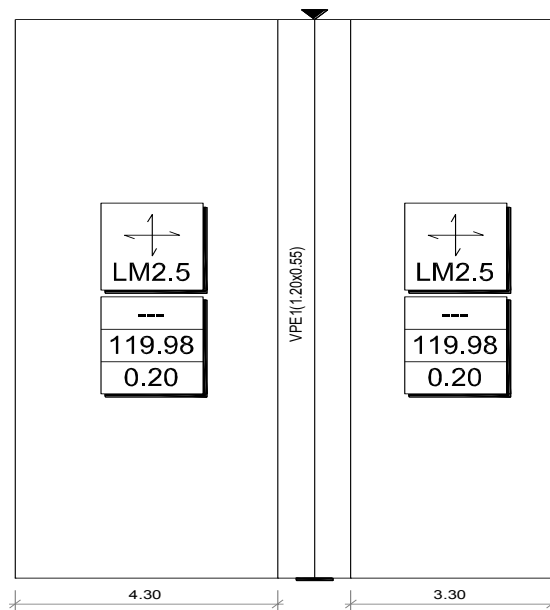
LAJES APOIADAS NA VIGA PRÉ-ESFORÇADA (AUTOCAD)
